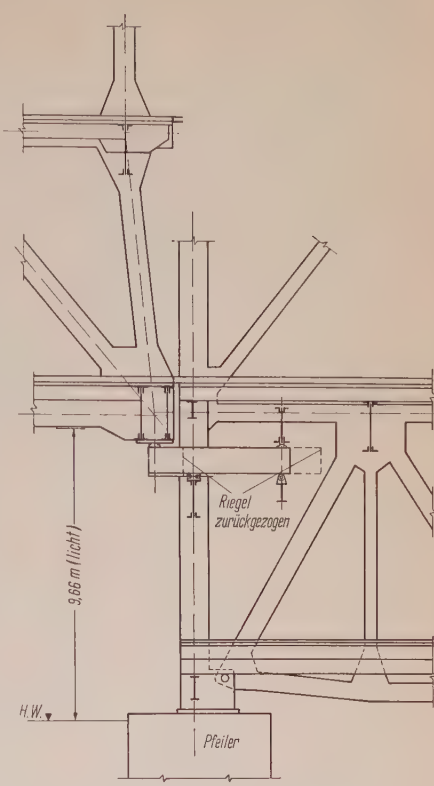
Hydraulisch betriebener Riegel als Lager für die mittlere Stellung der Hubbrücke
